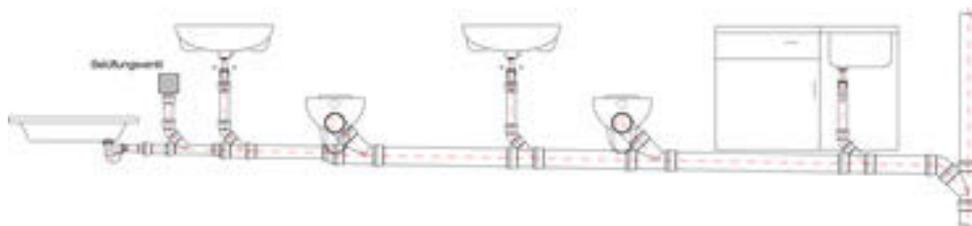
Belüftungsventil bei längeren Einzel- oder Sammelanschlussleitungen
